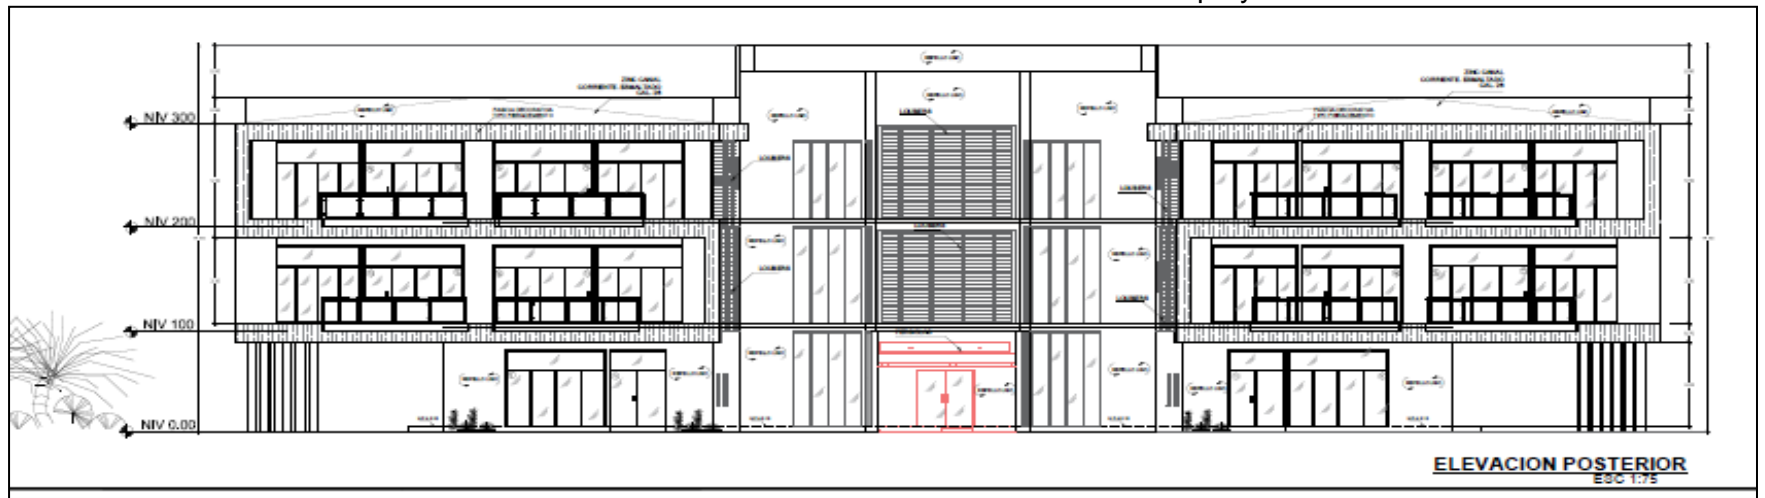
Elevación Posterior. Fuente: Planos de anteproyecto.
